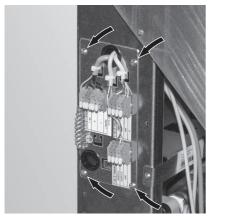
Avvitare saldamente la consolle di collegamento con viti autofilettanti – vista da davanti
